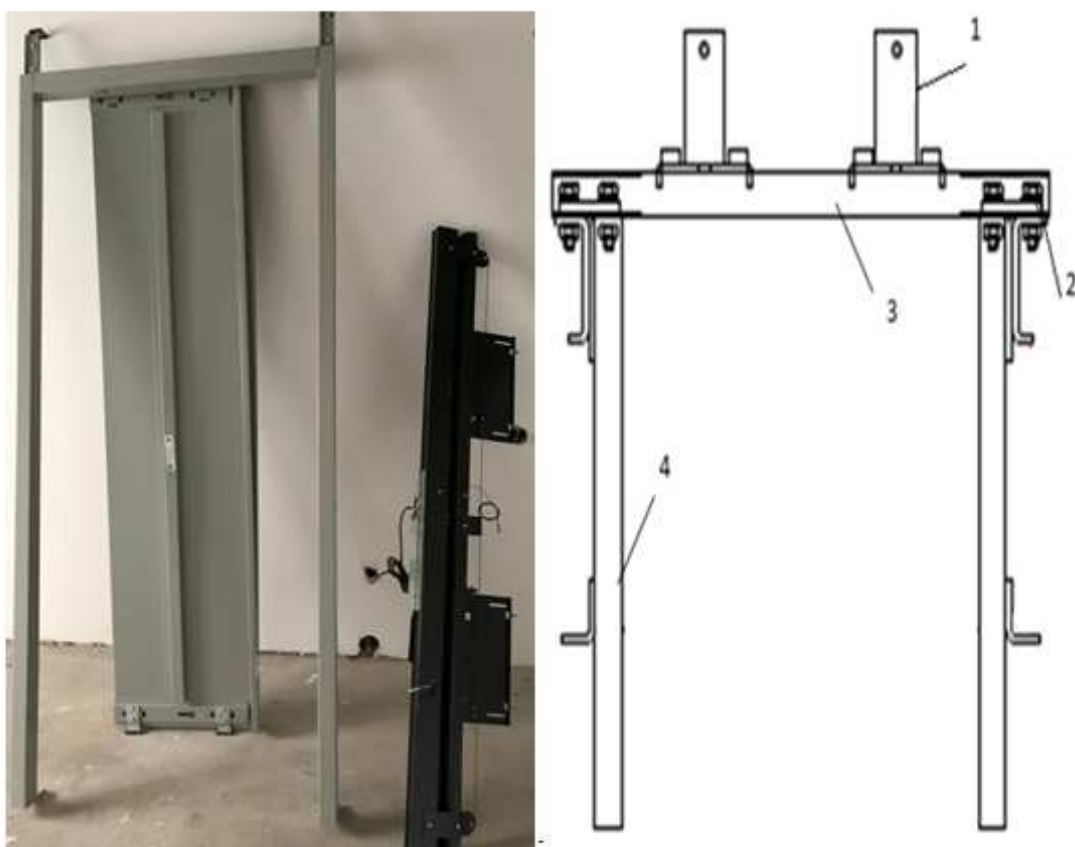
Элементы обрамлений дверных проемов и схема сборки стояков и верхней балки обрамления
